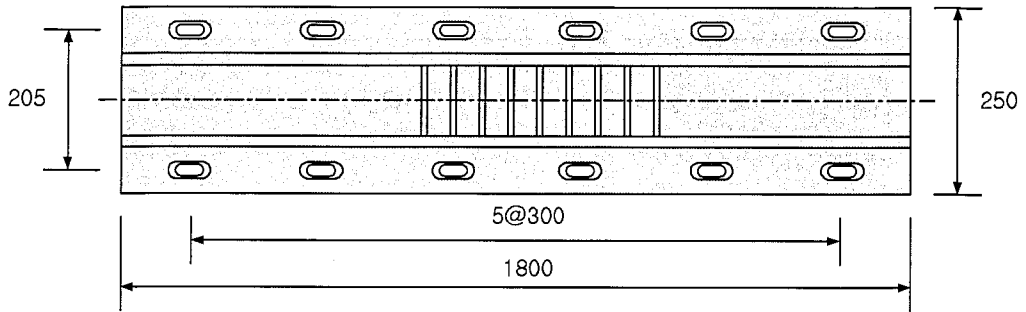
Transflex Joint의 평면도 (단위 : mm)
